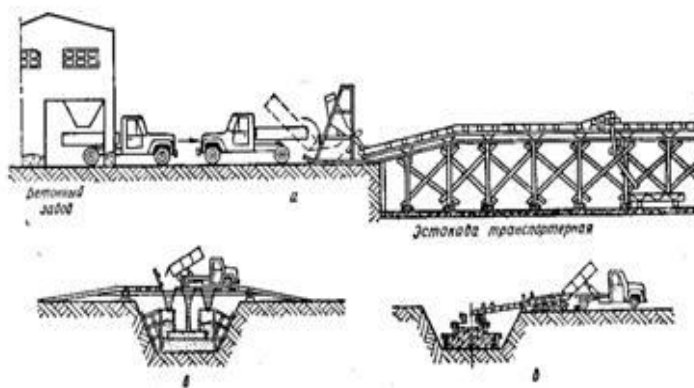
Схема укладки монолитного бетона в массивные конструкции:
